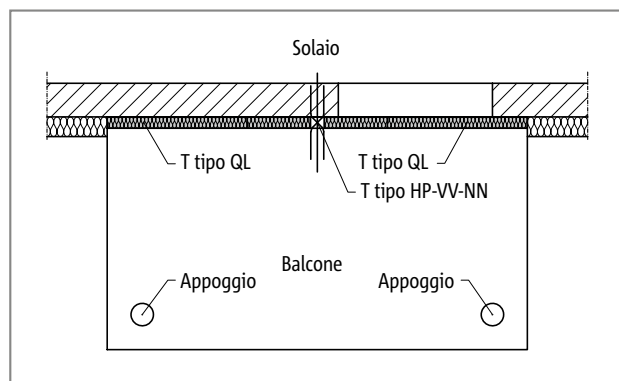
Schöck Isokorb® T tipo HP: balcone appoggiato su pilastri
